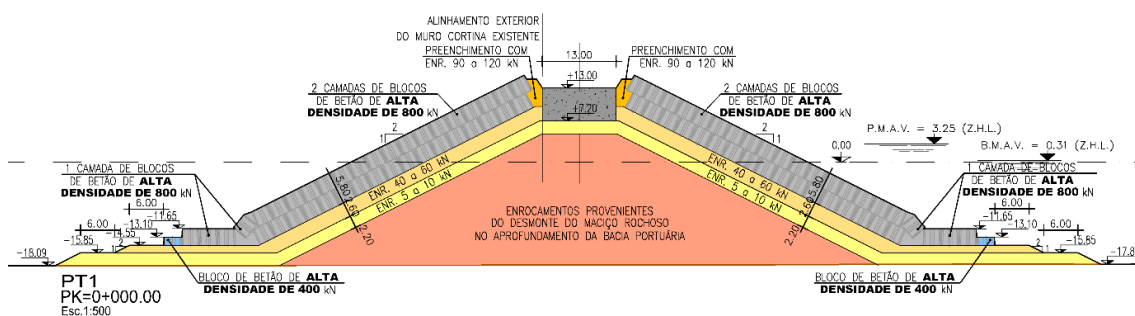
Perfil tipo da cabeça do molhe – Projeto de Execução.
